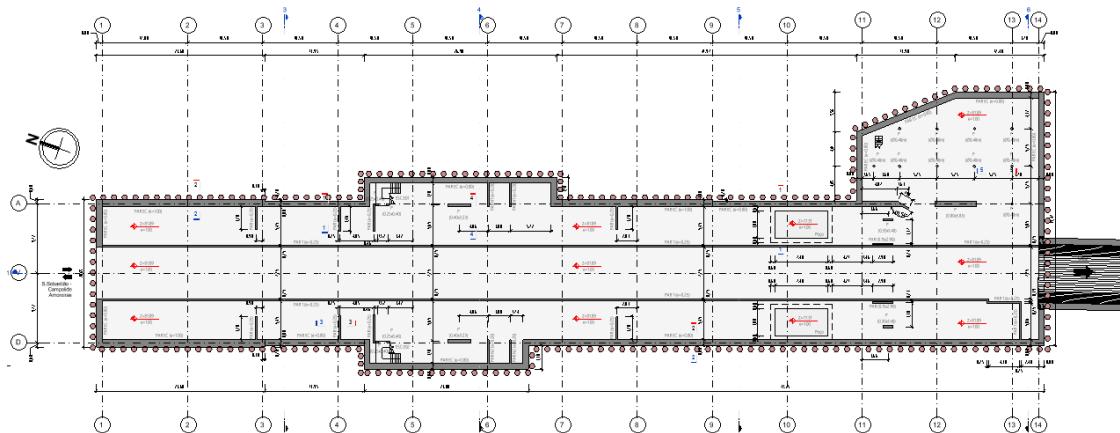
Planta ao nível do sub-cais (cota de topo do ensoleiramento geral)
